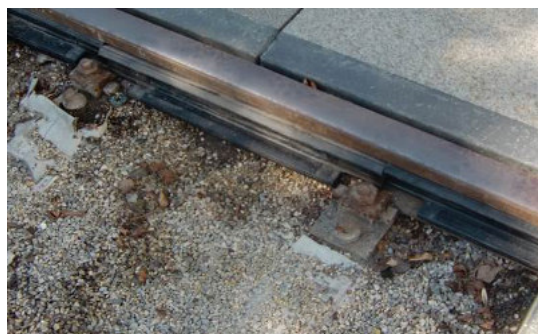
Die beiden Platten, inkl. 4 Stk. Abdeckkappen in der Kleiseisenausparung, werden im geklappten Zustand hochgehoben.
